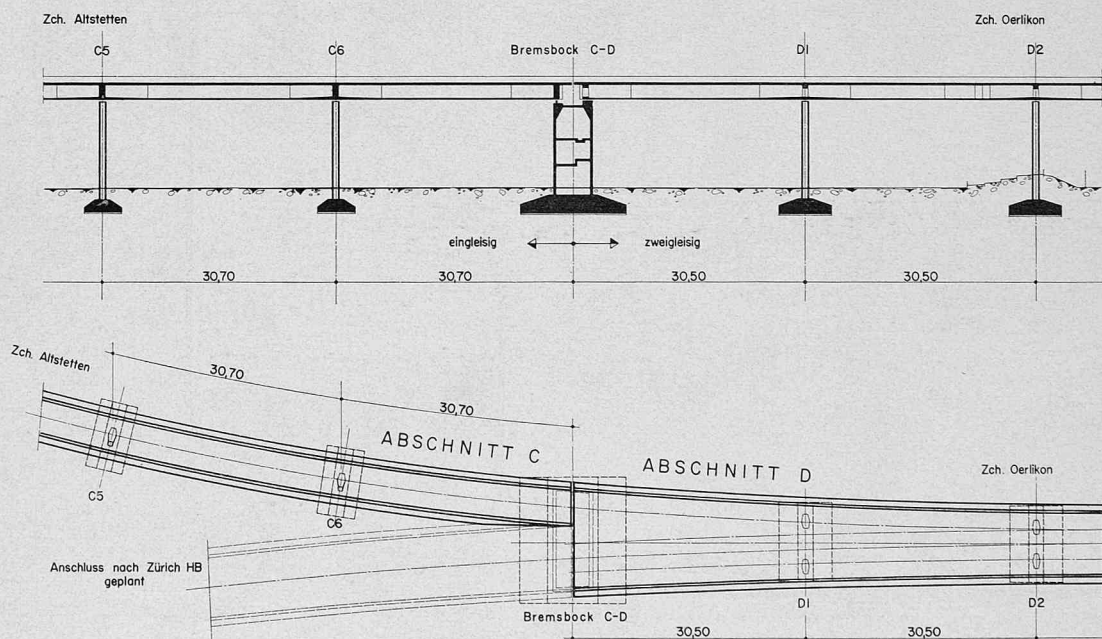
Abzweigstelle Herdern, Grundriss und Längsschnitt 1:1000
